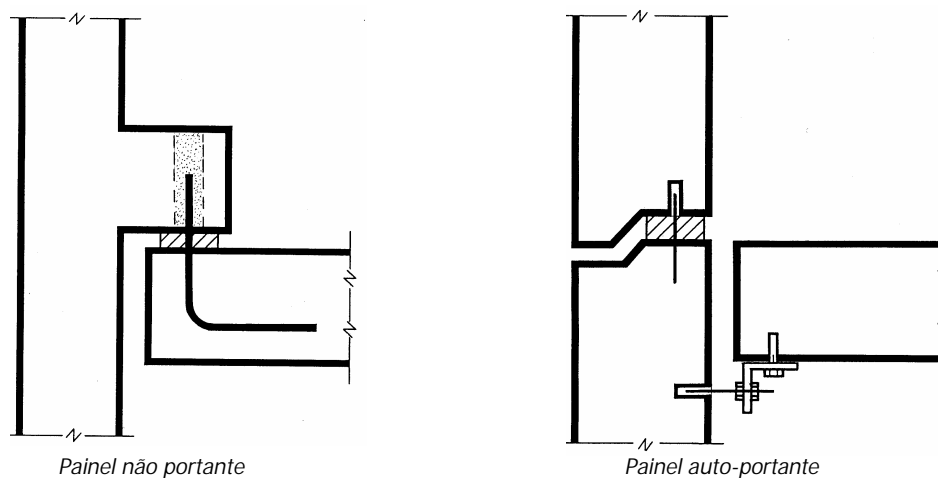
Princípio de fachadas auto-portante e não portante
